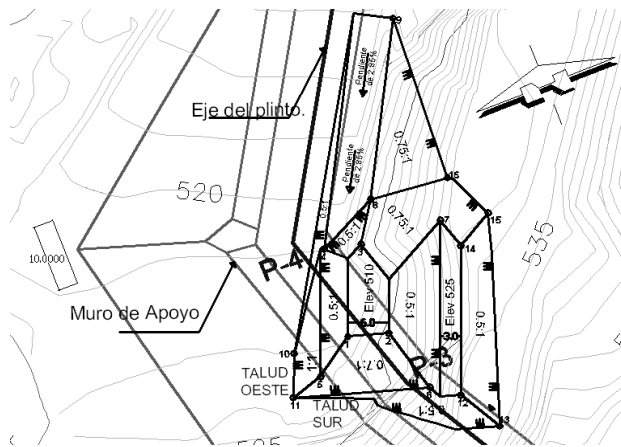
Planta de la excavación retirando el material de la zona 2.1
